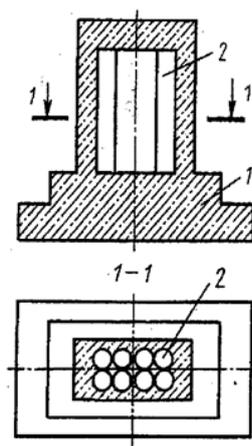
Массивный фундамент с пустообразователями: 1 – фундамент; 2 – пустообразователи
